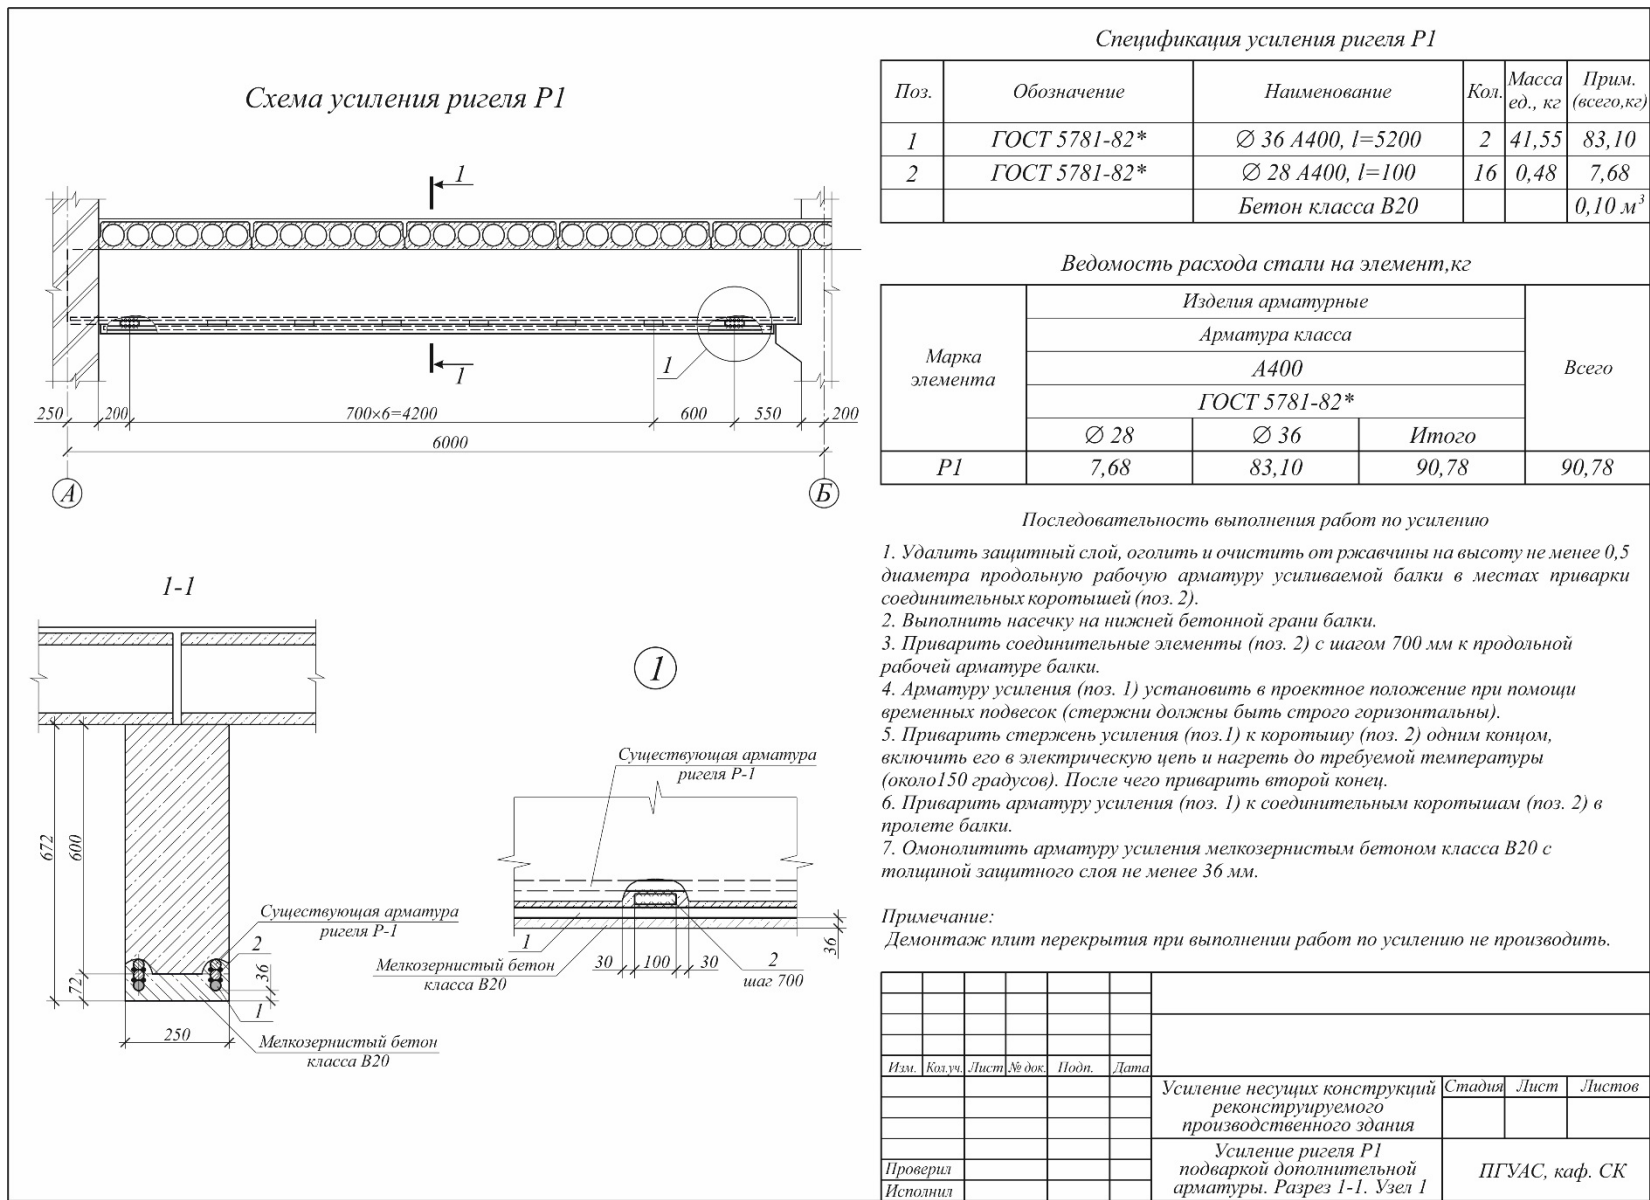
Чертеж усиления ригеля подваркой дополнительной арматуры
